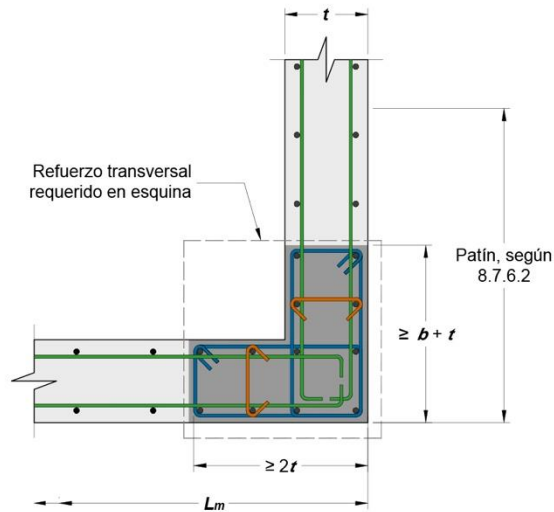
f – Ejemplo de configuración del refuerzo transversal donde no se requiere un elemento de borde en la esquina de un muro de ductilidad alta con patín
